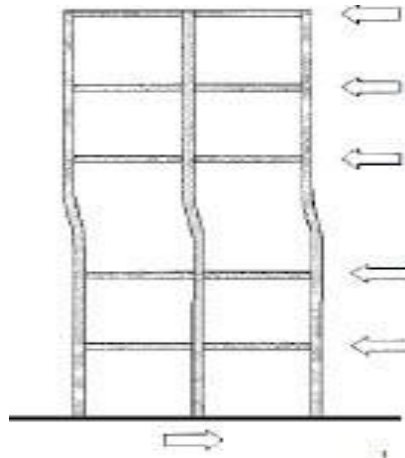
Bâtiment comportant un niveau ayant une hauteur plus grande que les autres niveaux [13].
